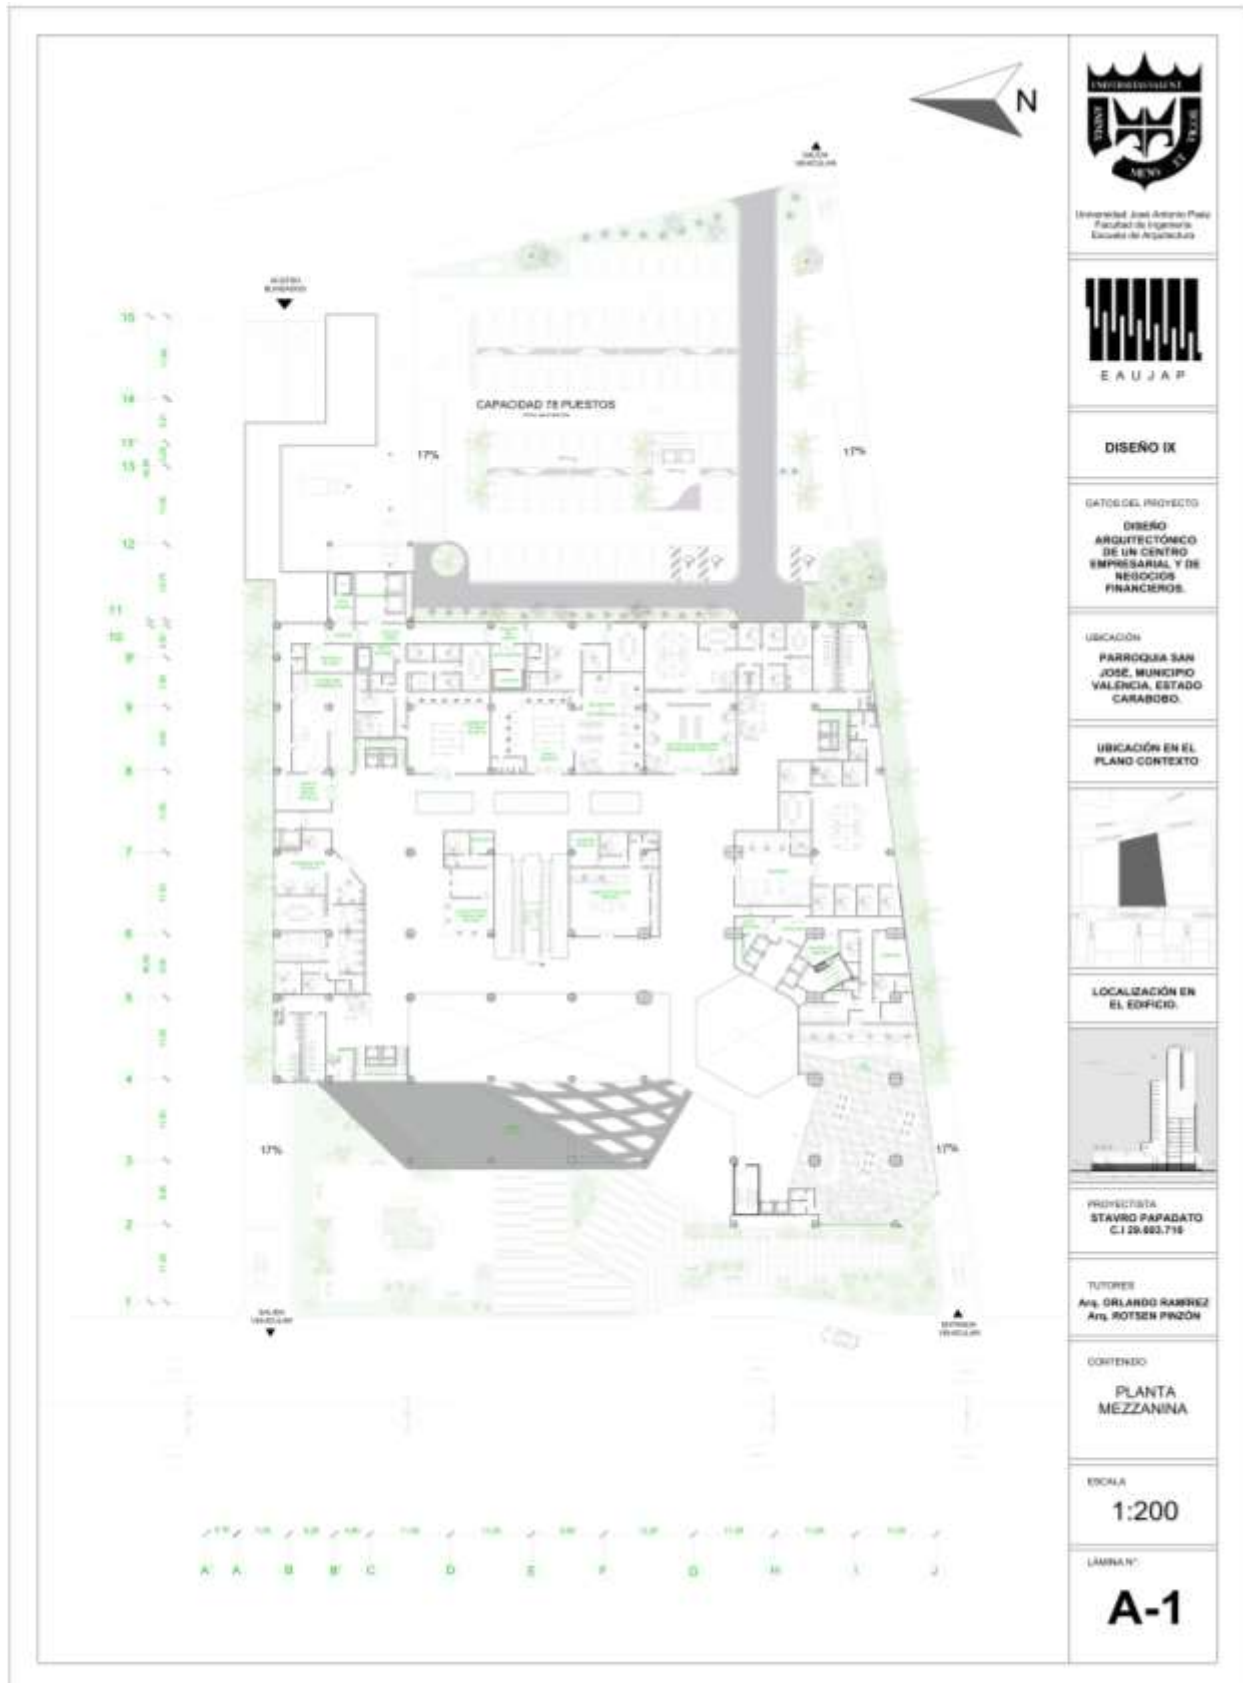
A-1 Planta Mezzanina Fuente: El Autor (2023)
